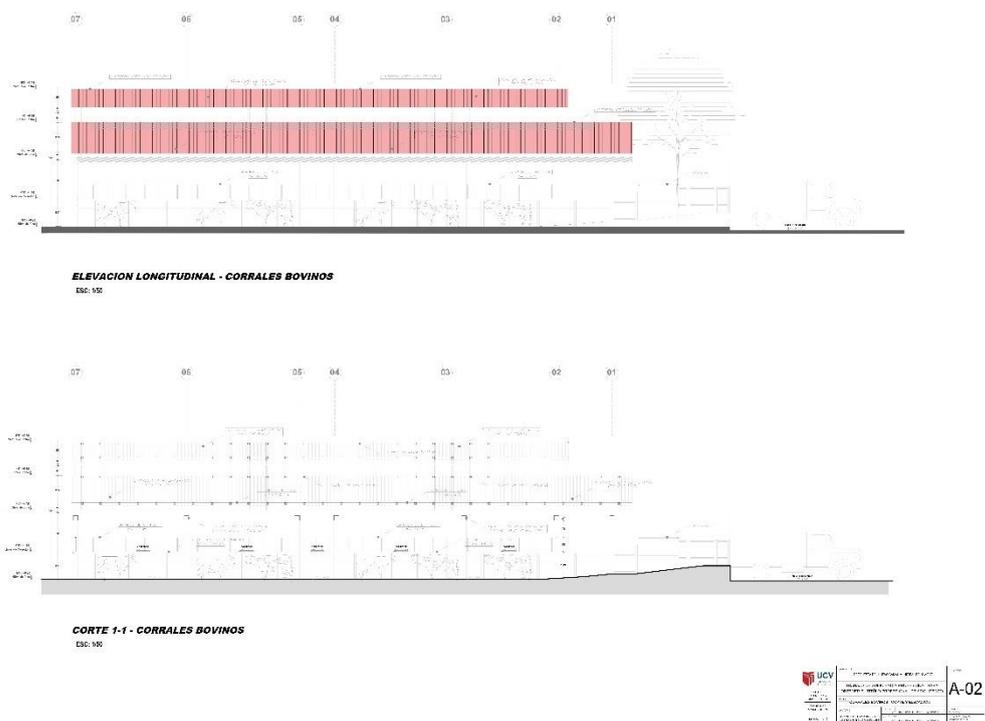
Plano de Elevacion Longitudinal en zona de Corrales de Bovinos
